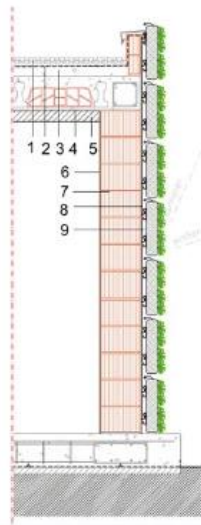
Sistema construtivo de fachada verde (Chàfer et al., 2021)
